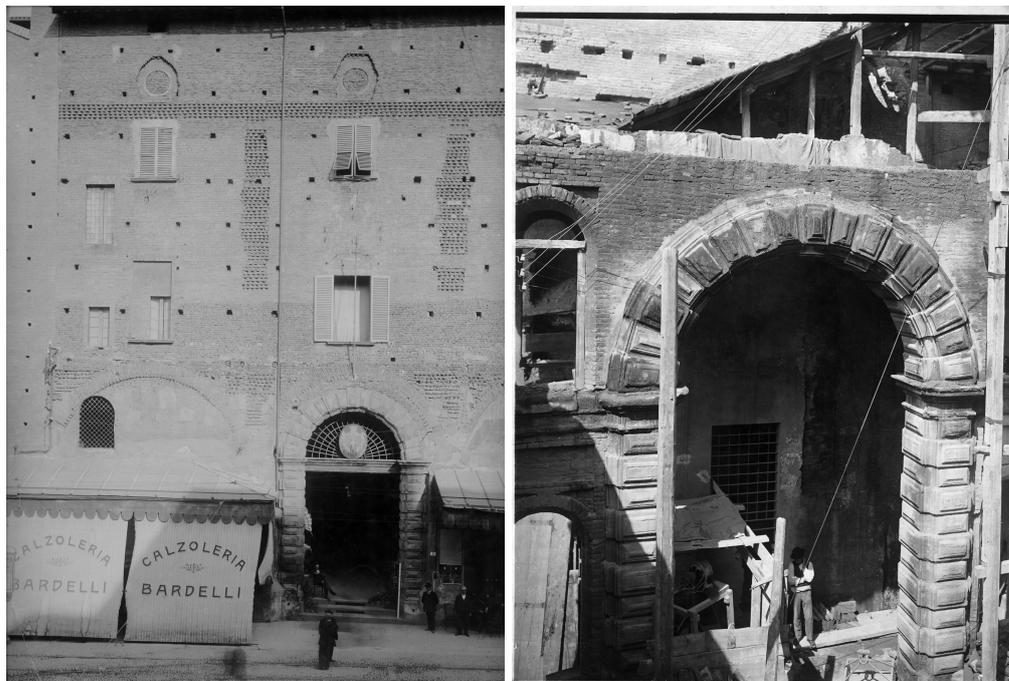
L'accesso principale al palazzo visto dall'esterno e dal cortile interno, dalle foto scattate in occasione dei restauri del Rubbiani. BSA-02-06-F031 e BSA-02-05-F013
